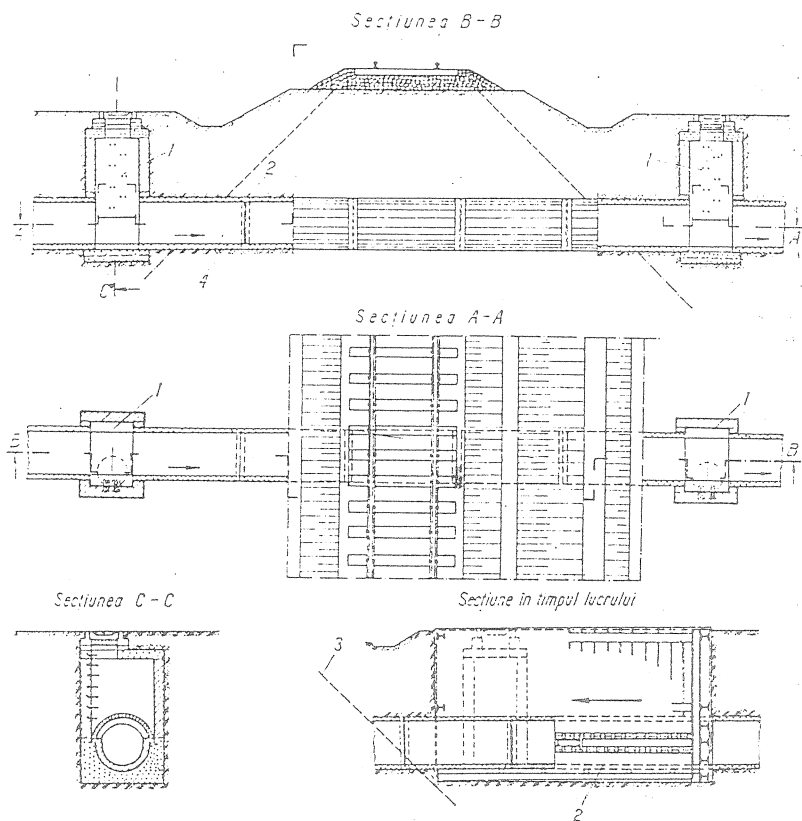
Traversare pe sub cale ferată; canalul este executat din tuburi de beton armat: 1 — cămin; 2 — inel de oțel; 3 — linie de presiune; 4 — tub de beton armat.
